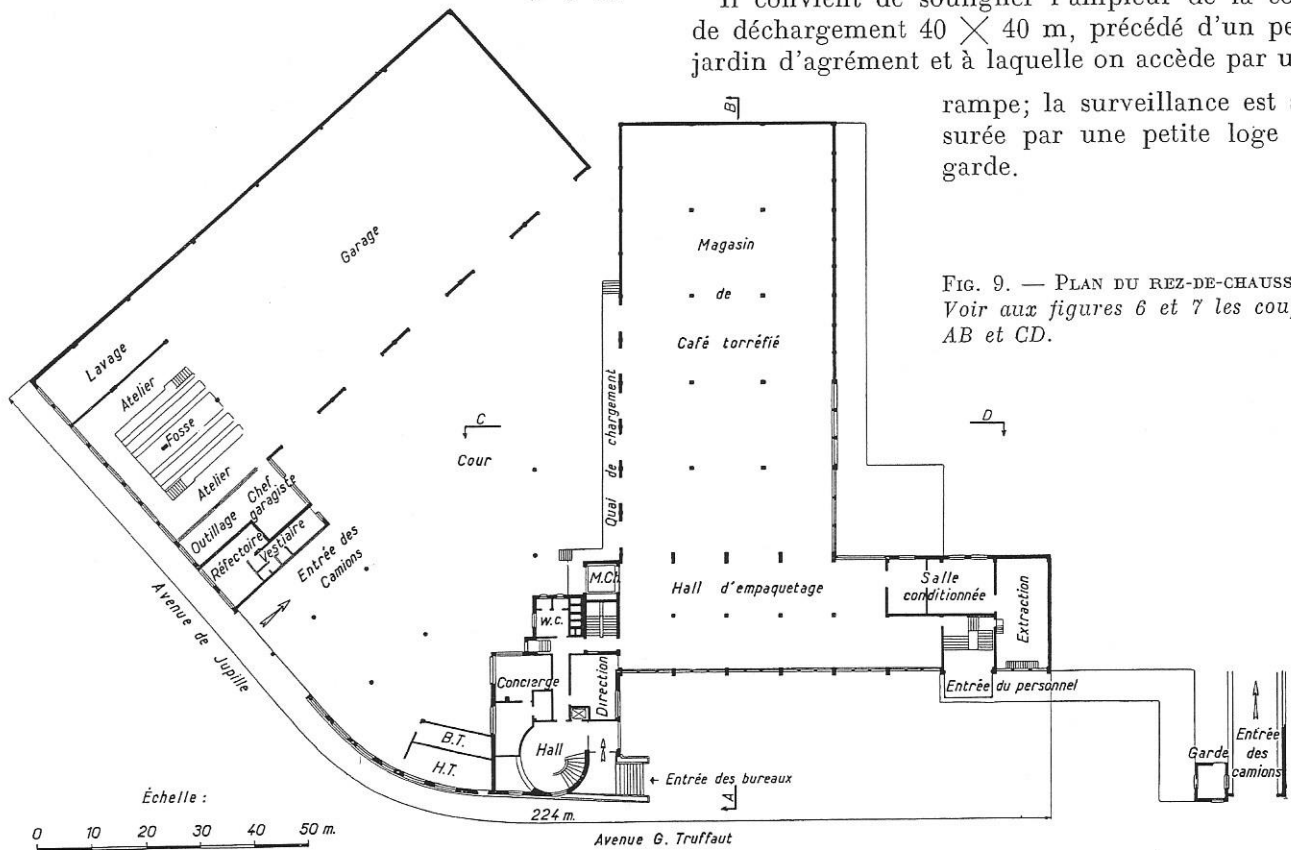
PLAN DU REZ-DE-CHAUSSÉE. Voir aux figures 6 et 7 les coupes AB et CD.
